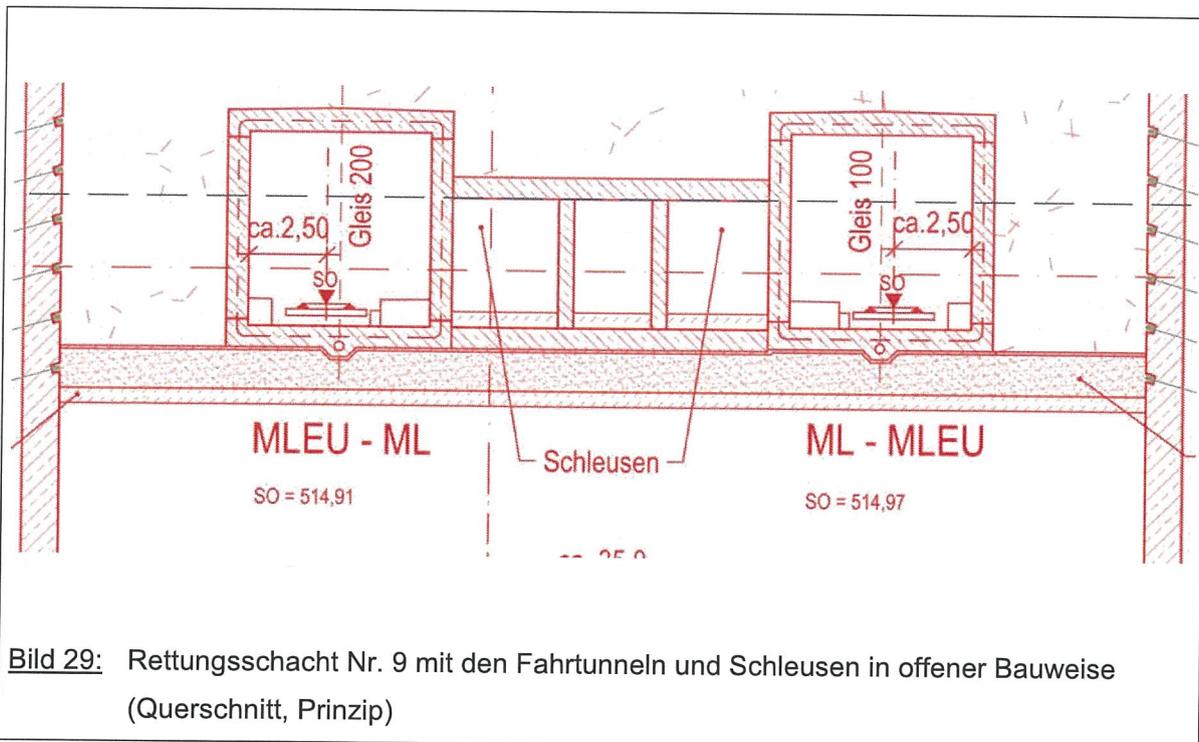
Rettungsschacht Nr. 9 mit den Fahrtunneln und Schleusen in offener Bauweise (Querschnitt, Prinzip)
